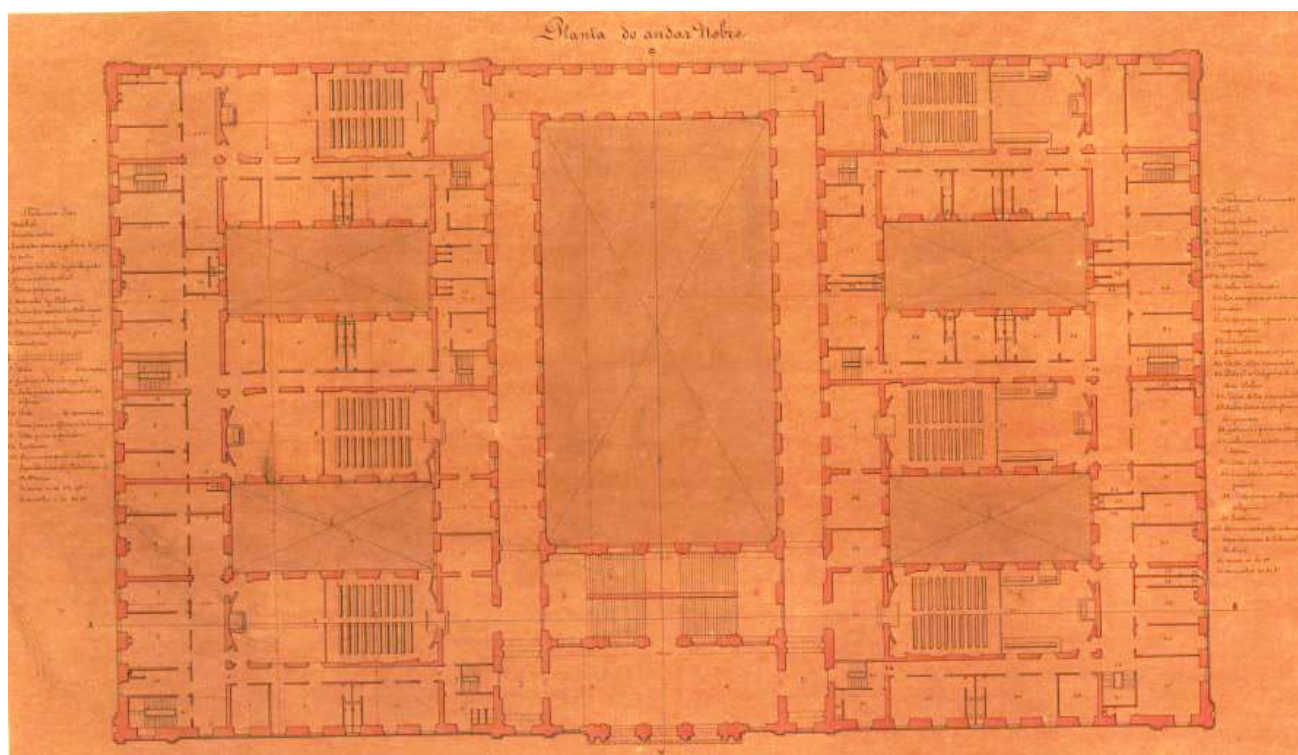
Planta do andar nobre, Palácio da Justiça. Rafael da Silva Castro, 1876-1879 (?). ANTT, Casa Real, Plantas, Plantas Diversas, Ca-PT-TT-CR-Plantas-Pasta23-N566\_c0002.
